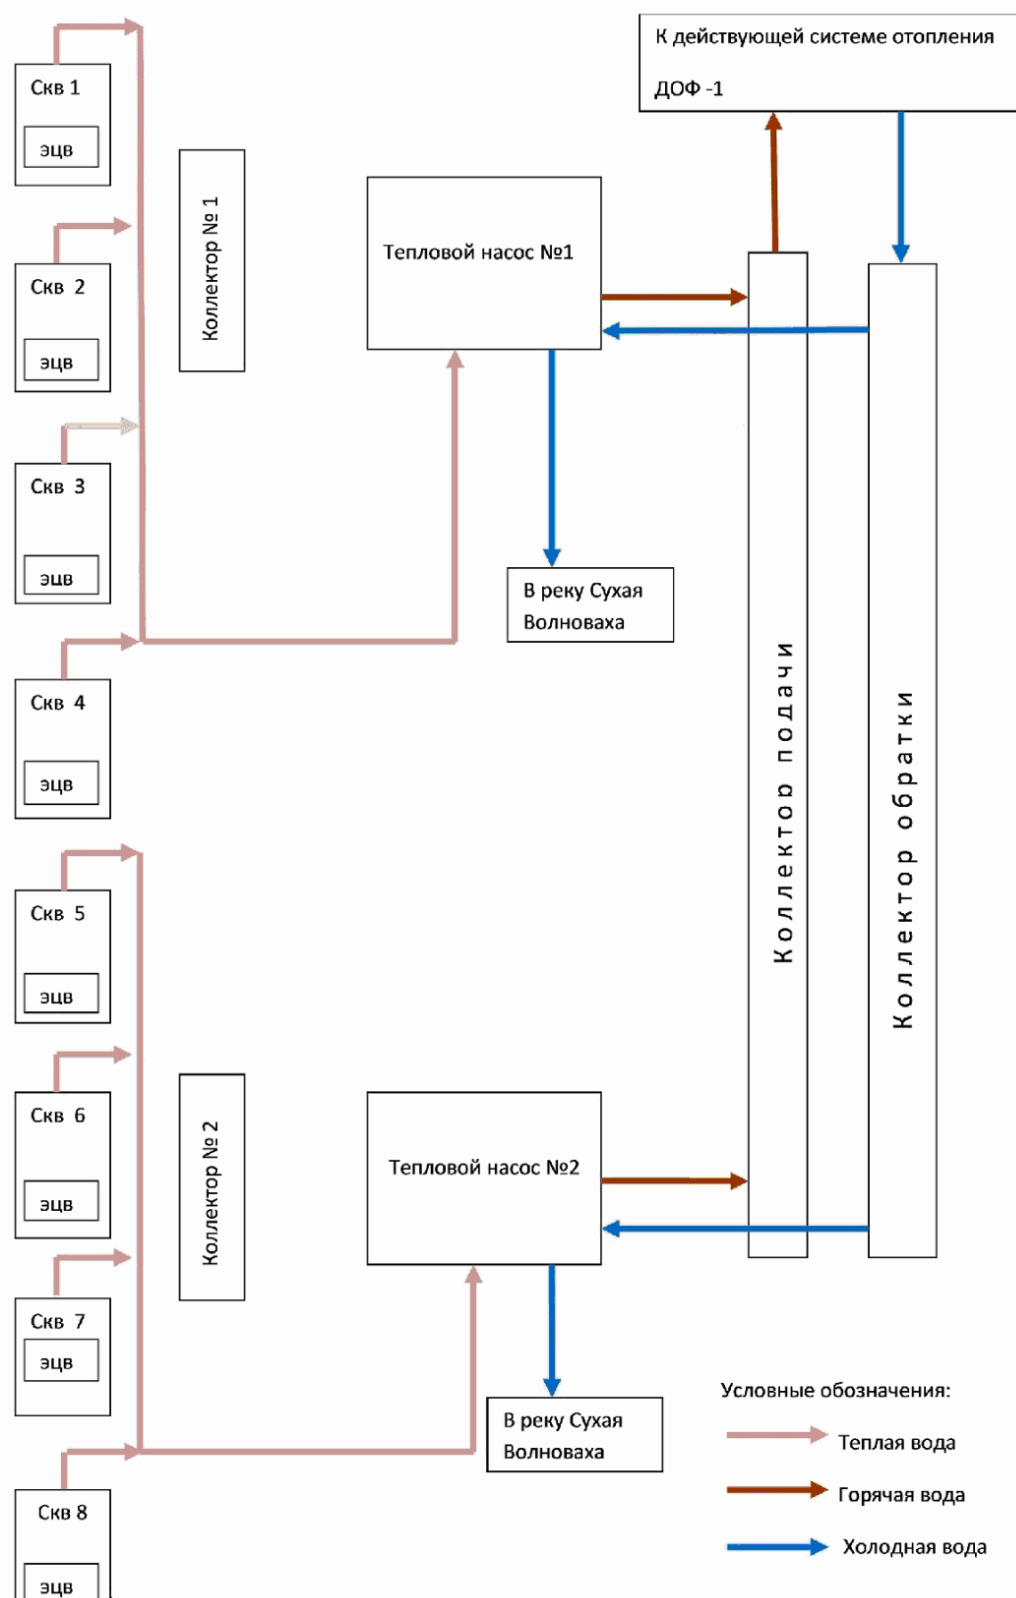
Схема отопления ДОФ-1 при помощи теплового насоса
